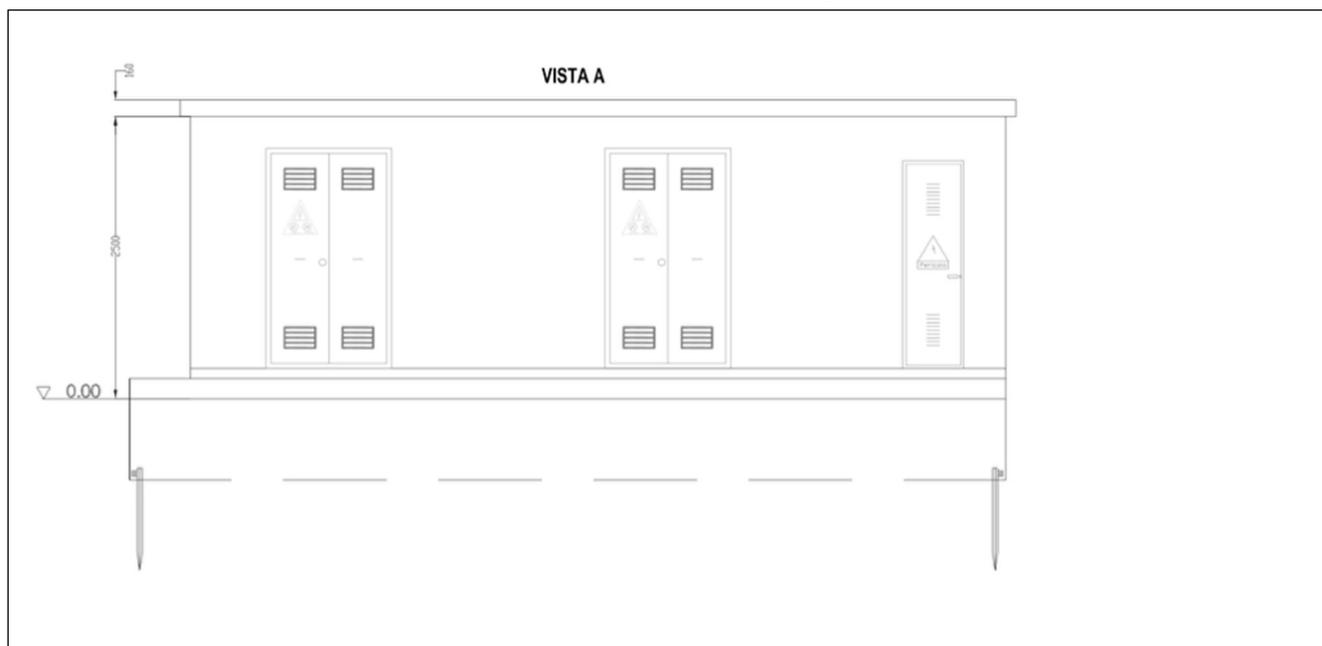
Locale cabina di Parallelo MT-Prospetto
